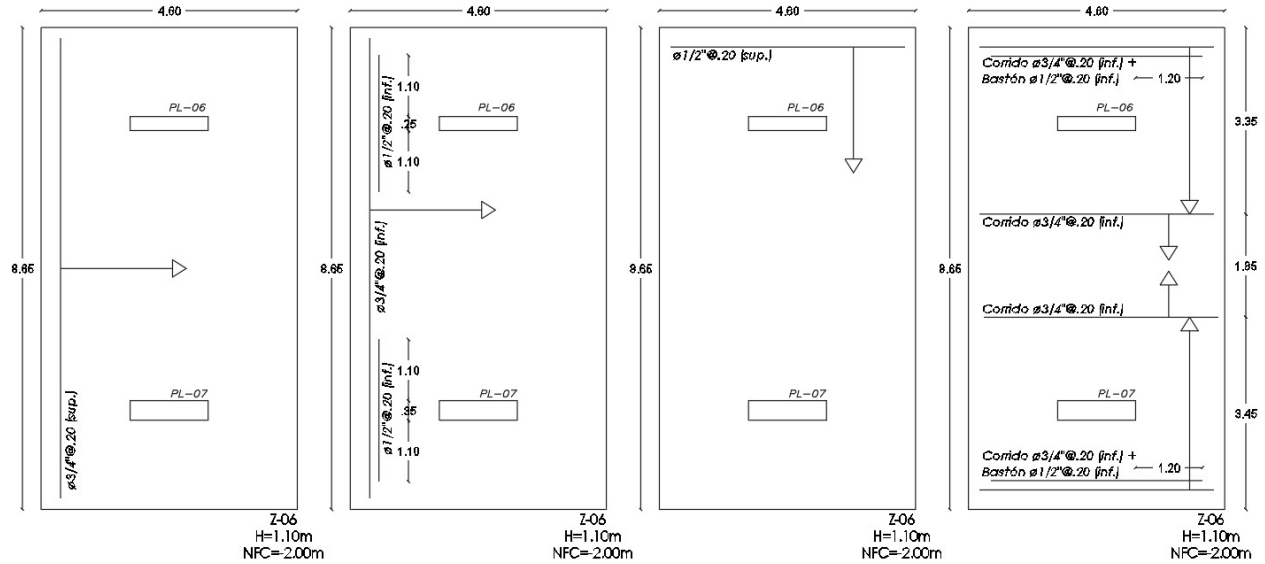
Disposición final de refuerzo transversal en zapata Z-06.
